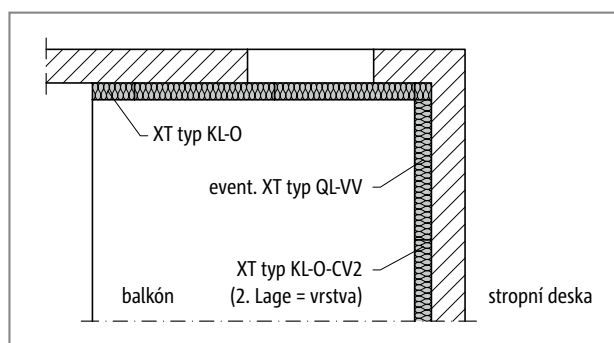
Schöck Isokorb® XT typ KL-U/KL-O: Volně vyložený balkón
